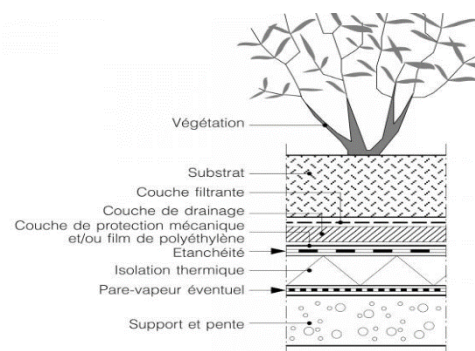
schéma de toiture intensive source : NIT 229 - Les toitures vertes, CSTC, Bruxelles
